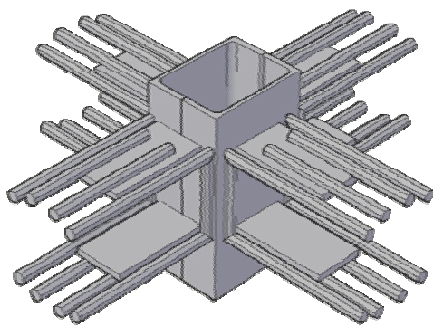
Металеві конструкції безкапітального вузла з'єднання монолітного безбалкового перекриття з колонами зі швелерів
